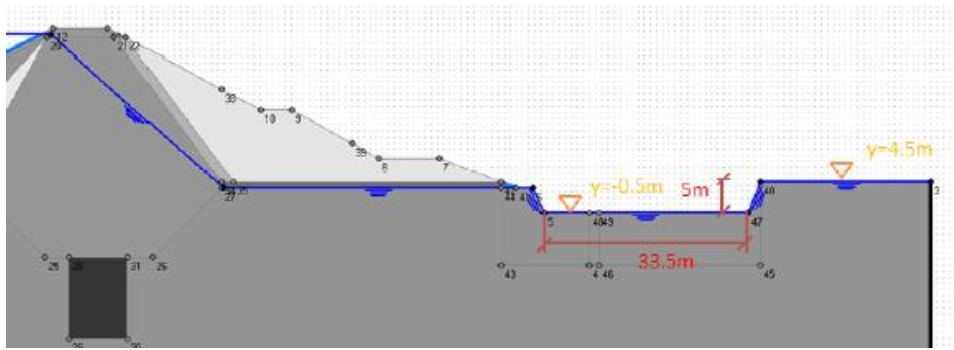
Dimensões da escavação proposta (Plünnecke, 2014).
